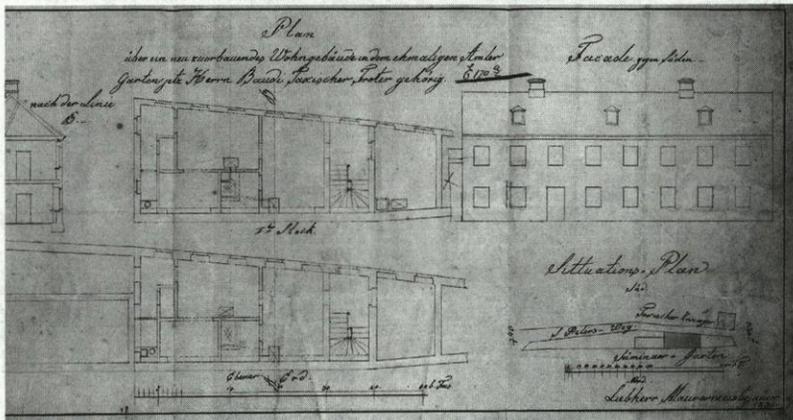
St. Peters-Weg 9, Lageplan (Ausschnitt aus Bauplan von 1834, BOAR).
